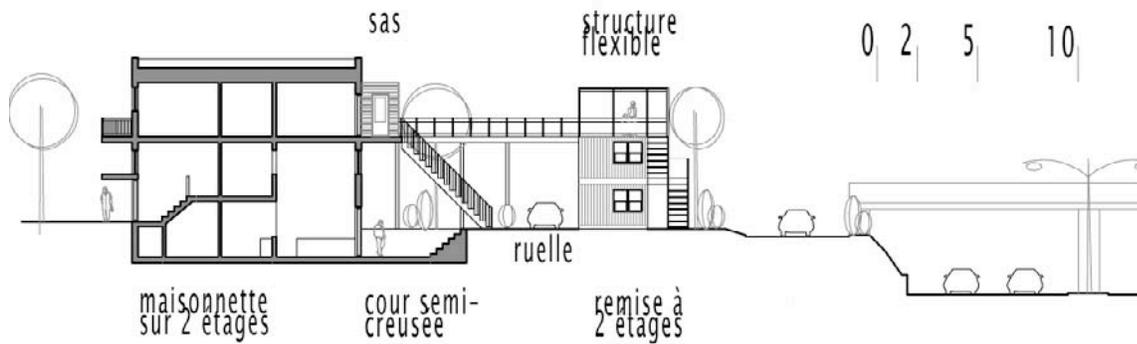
Coupe transversale dans le walk-up réaménagé qui comporte un logement sur deux niveaux au rez-de-chaussée et un logement au dernier étage. Les coursives relient le « mur-écran habité » aux logements (l'autoroute Duplessis est à droite).
